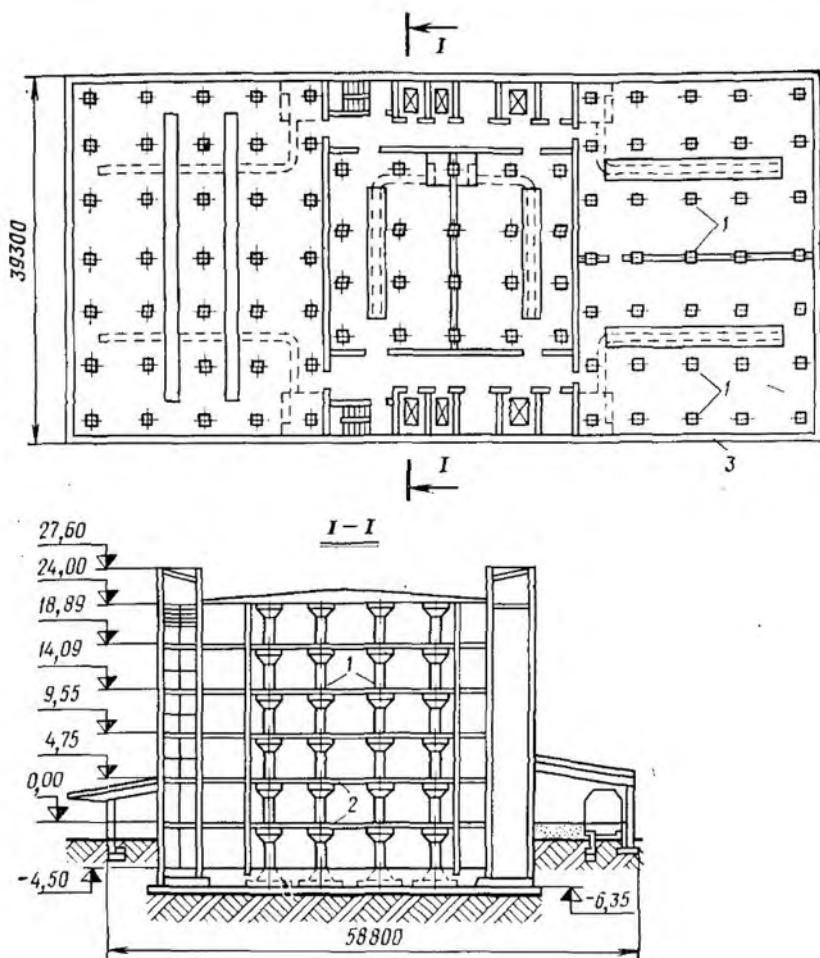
Многоэтажный холодильник с железобетонным безбалочным каркасом: а — план типовых верхних этажей; б — разрез; 1 — колонны с капителями; 2 — плиты перекрытий; 3 — стены кирпичные, самонесущие.
